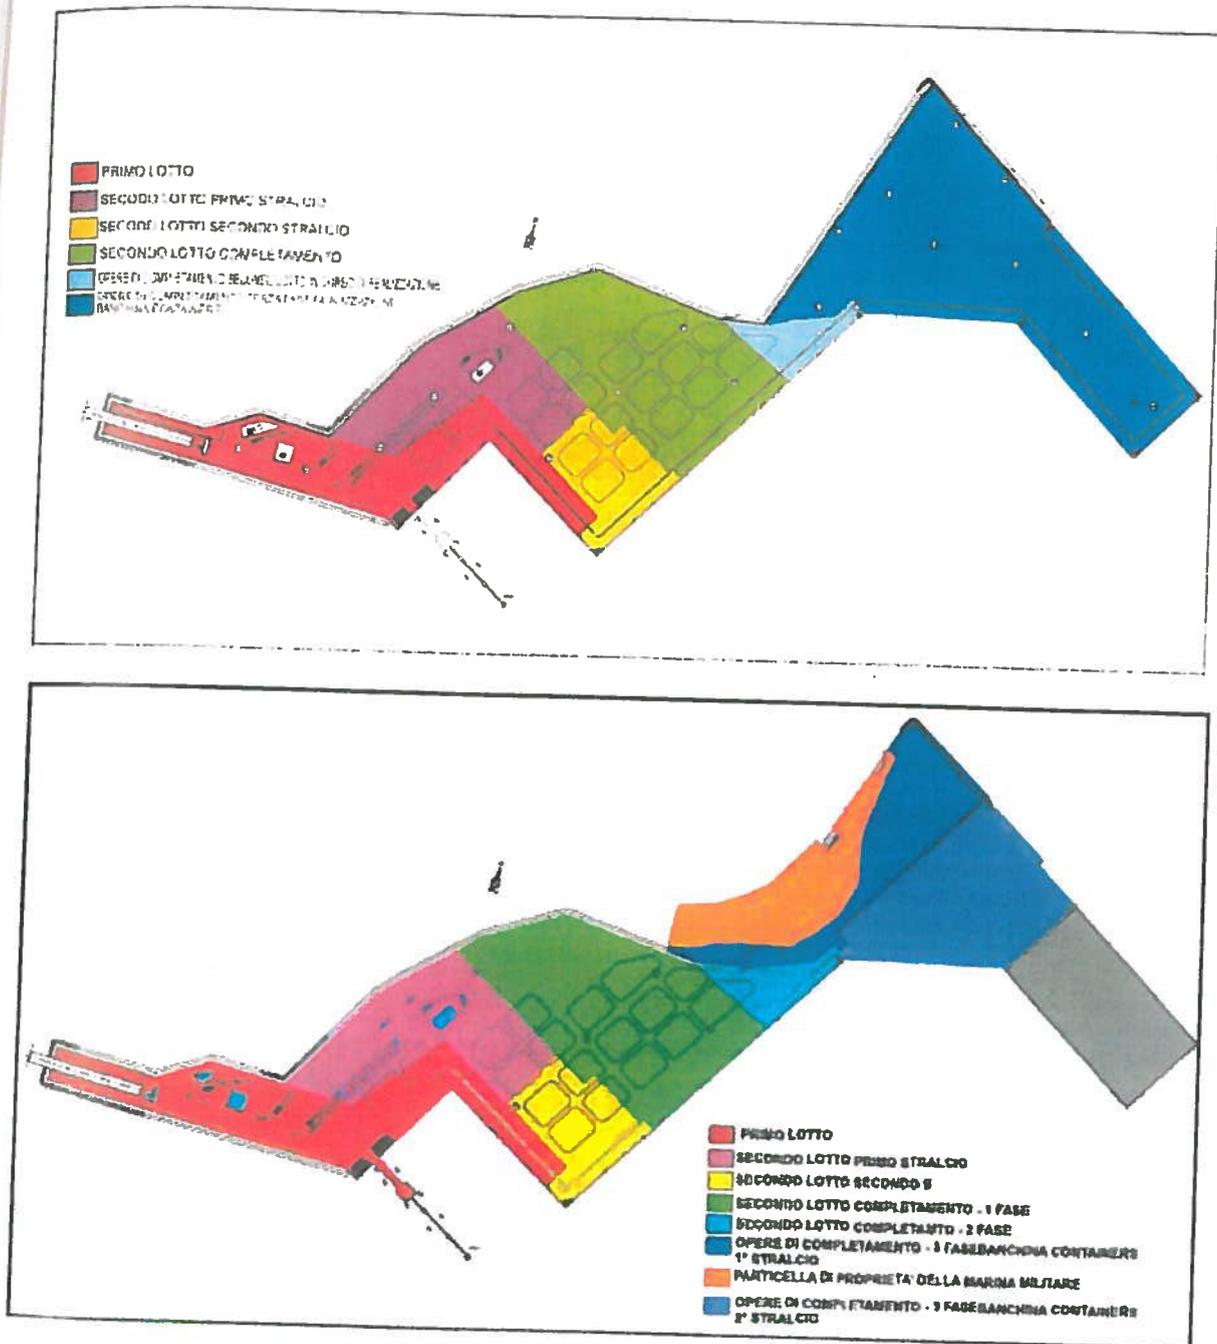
Planimetria del porto con le varie fasi di realizzazione
